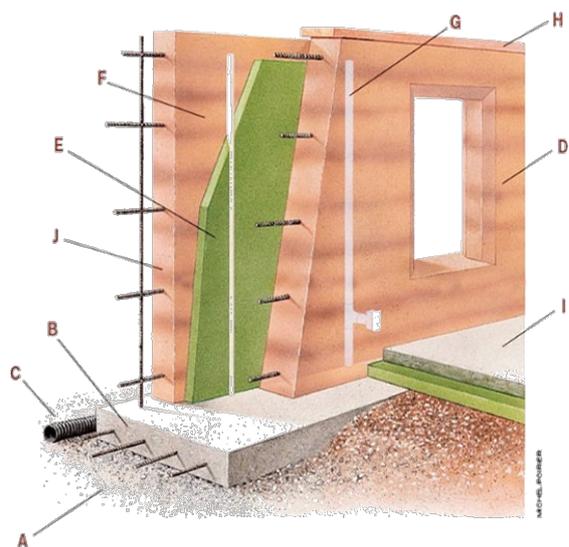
Разрез стены SIREWALL: А – подушка под фундамент из щебня; В – армированная плита фундамента; С – дренажная труба; D – армированная землебитная стена; Е – слой теплоизоляции (полиизоциануратная пена); F – наружная армированная землебитная стена; G – кабель каналы; H – мауэрлат, скрепленный на анкерах; I – пол помещения; J – водорастворимый акриловый герметик.
